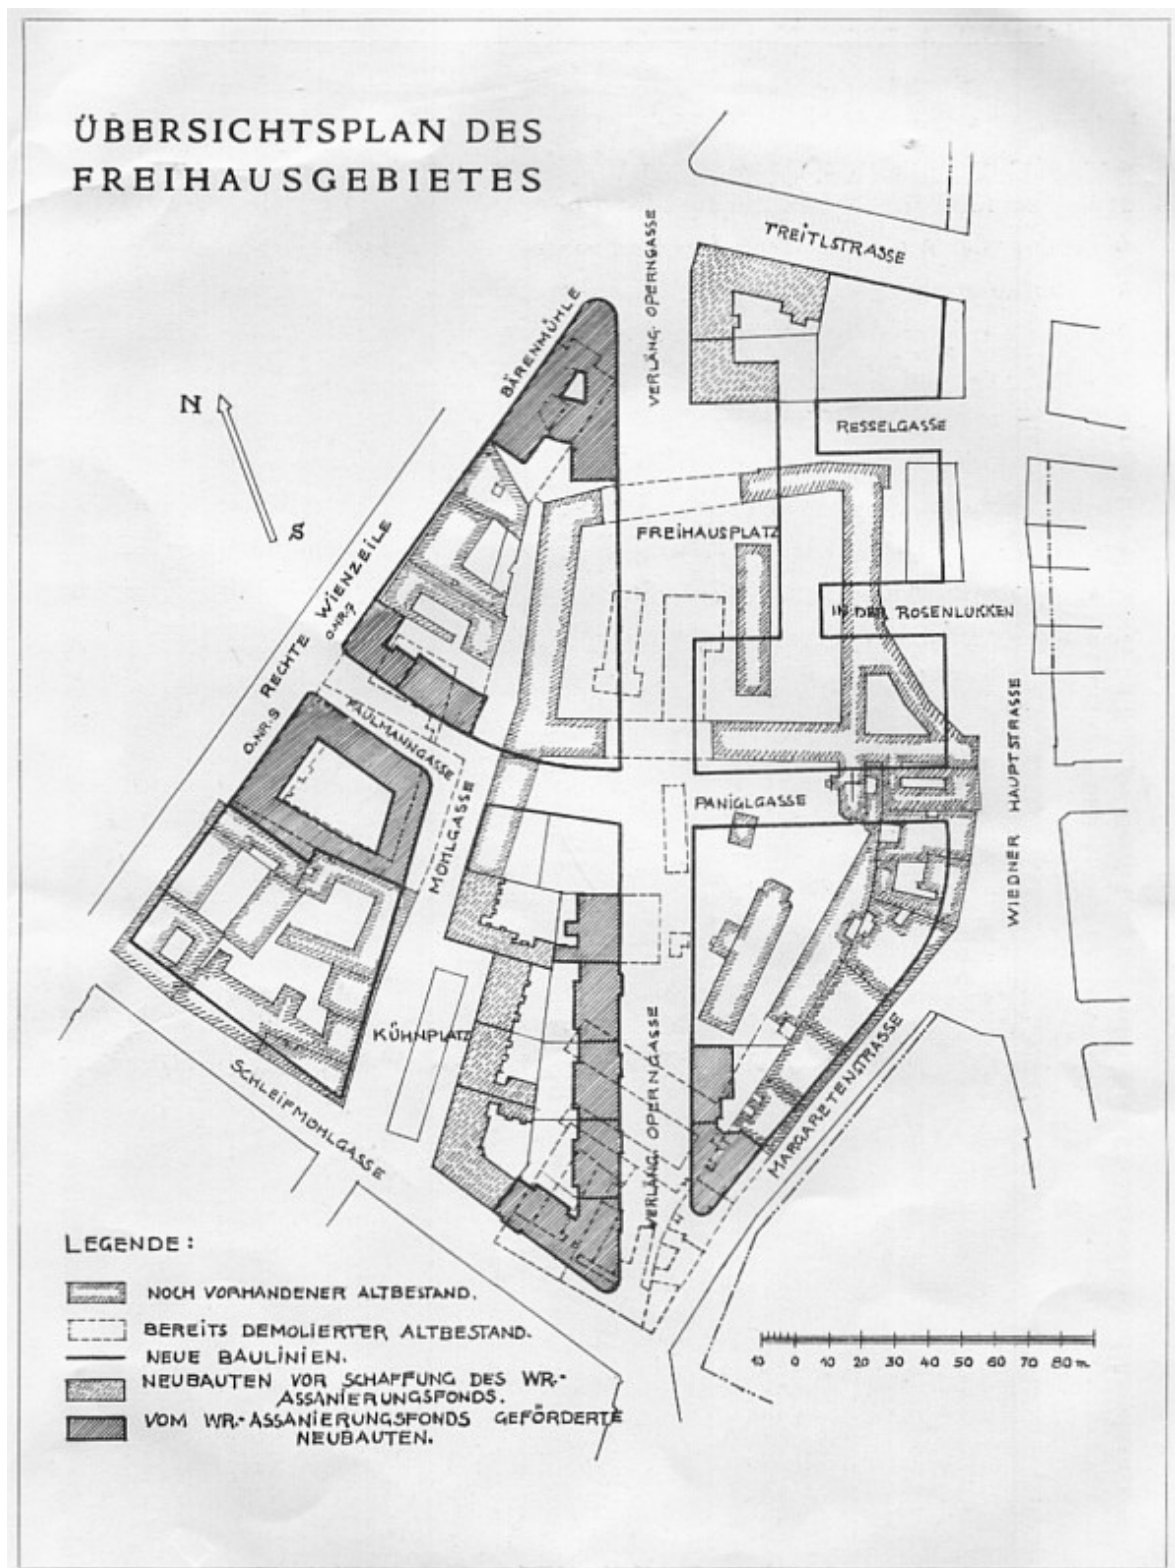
Assanierung des Freihausviertels: Zu erkennen sind die Grundrisse der Assanierungsbauten Rechte Wienzeile 1 („Bärenmühle“, oben), 7 und 9 (links).
